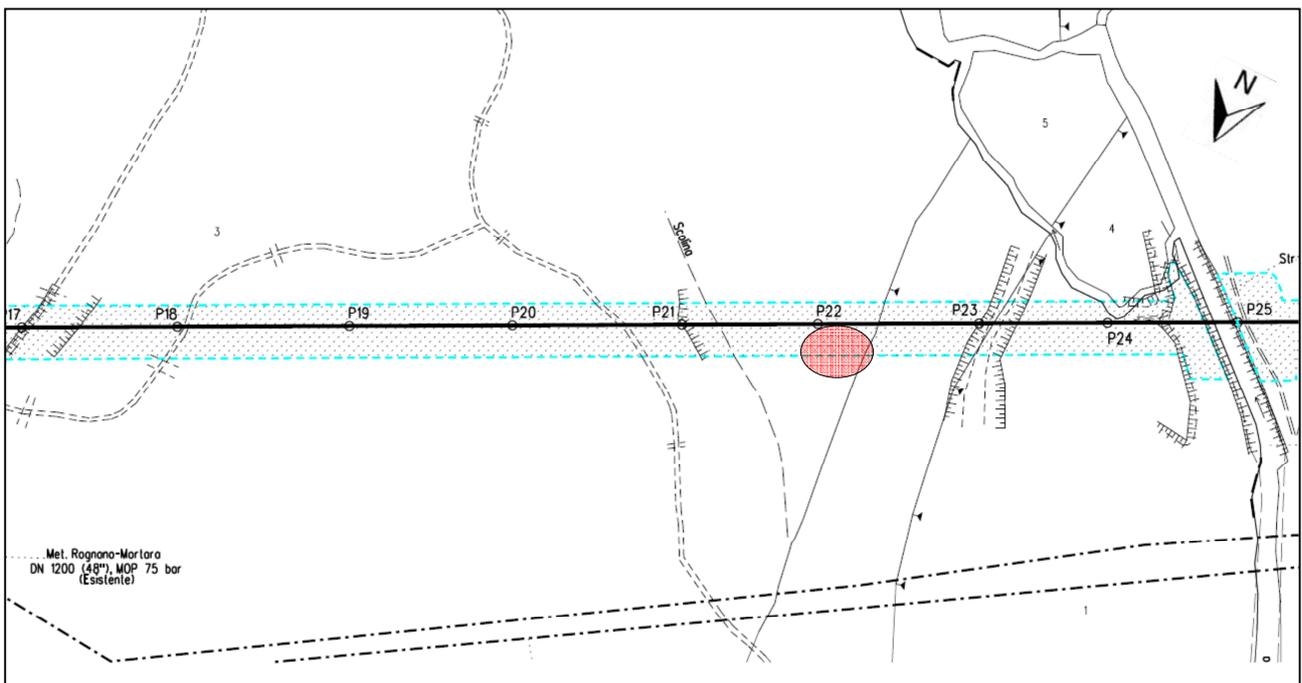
Localizzazione Area Test VEP 04 VG su planimetria catastale
